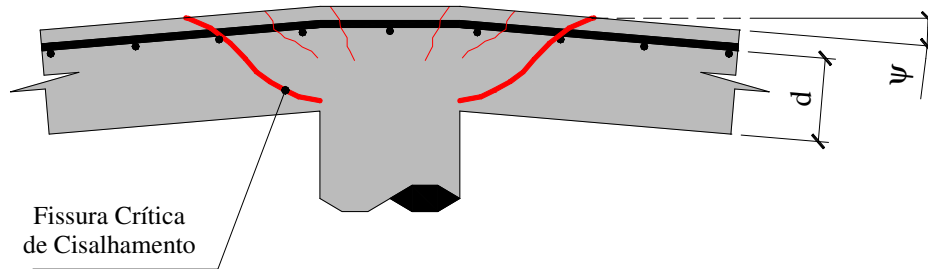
Rotação da laje ao redor da região de apoio – CEB-FIP (2010)
